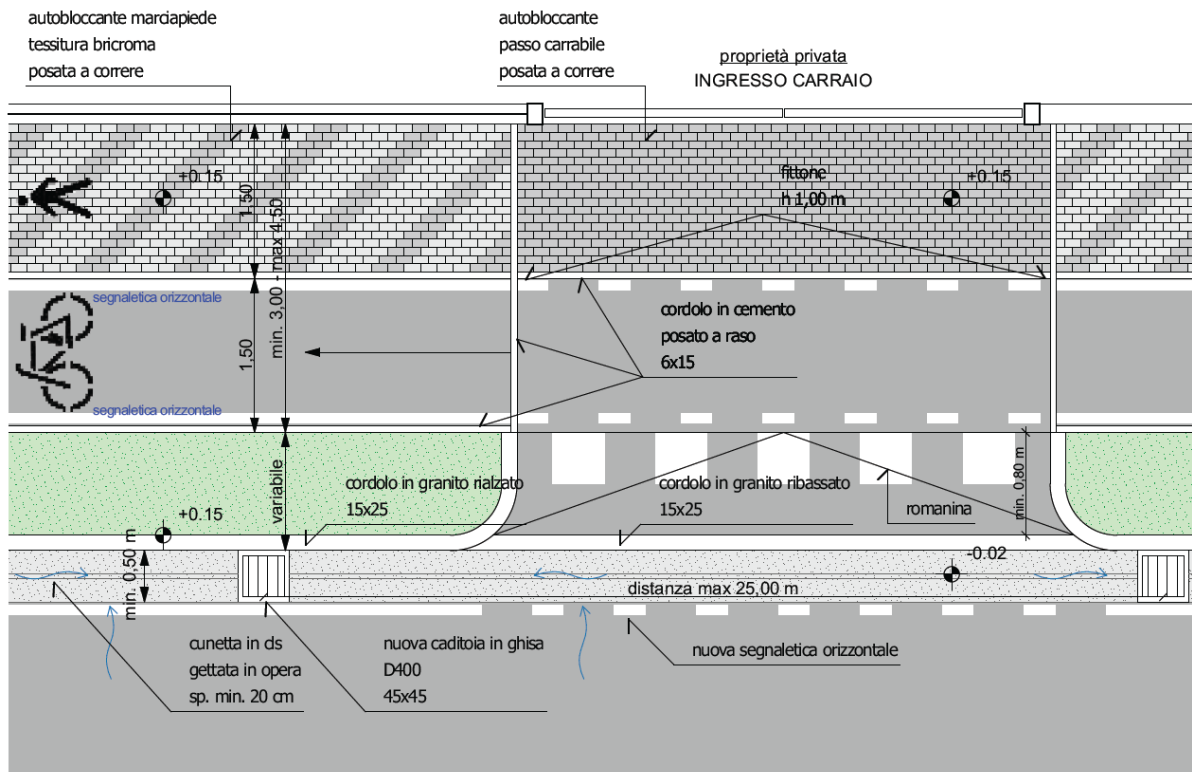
Estratto Tav. 6.9 – Dettagli
